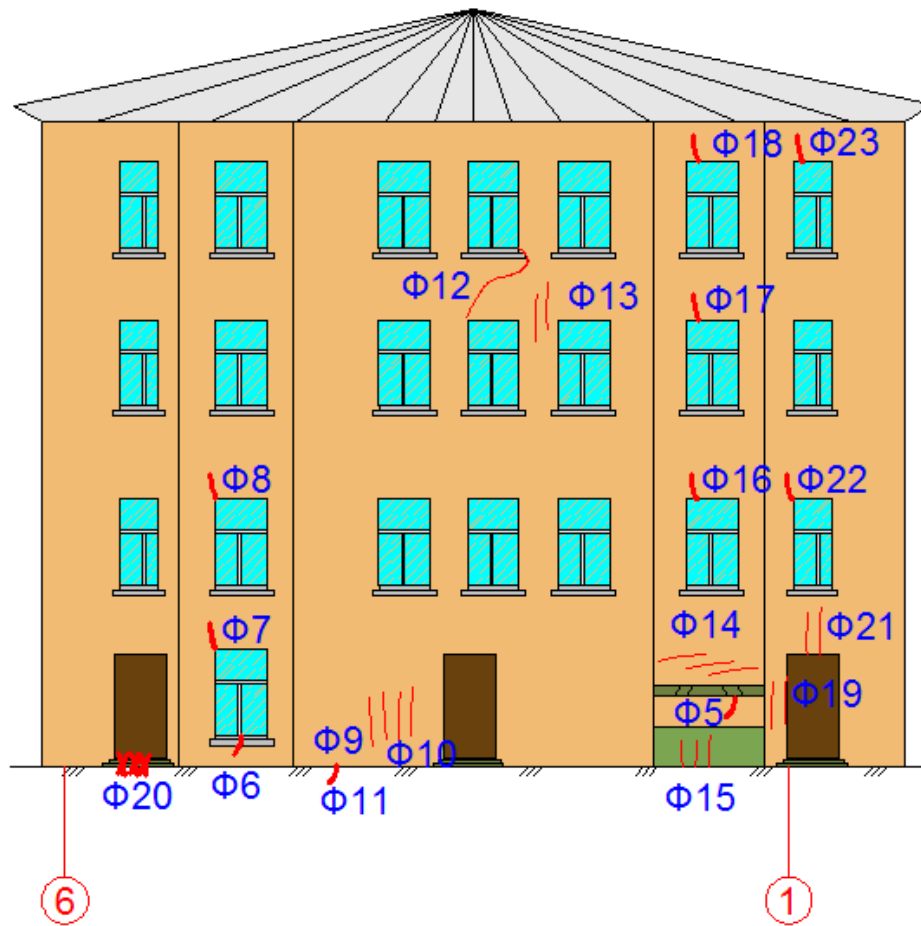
Схема дефектов фасад по оси «Ж». Фасад со стороны внутреннего дворика.
